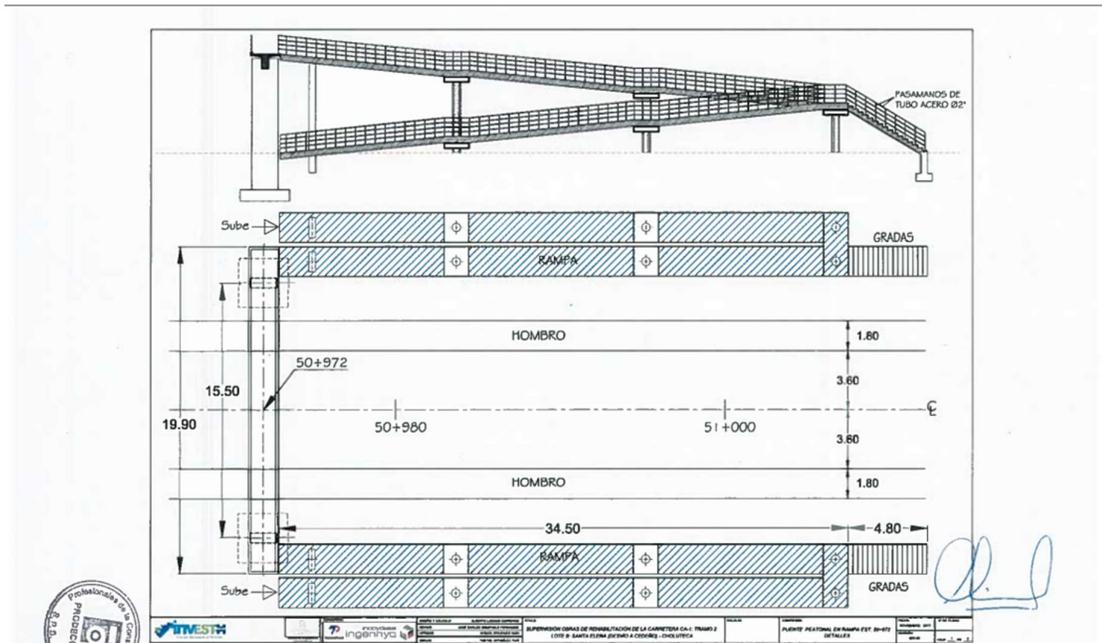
Plano de Planta del Puente Peatonal con Rampa
